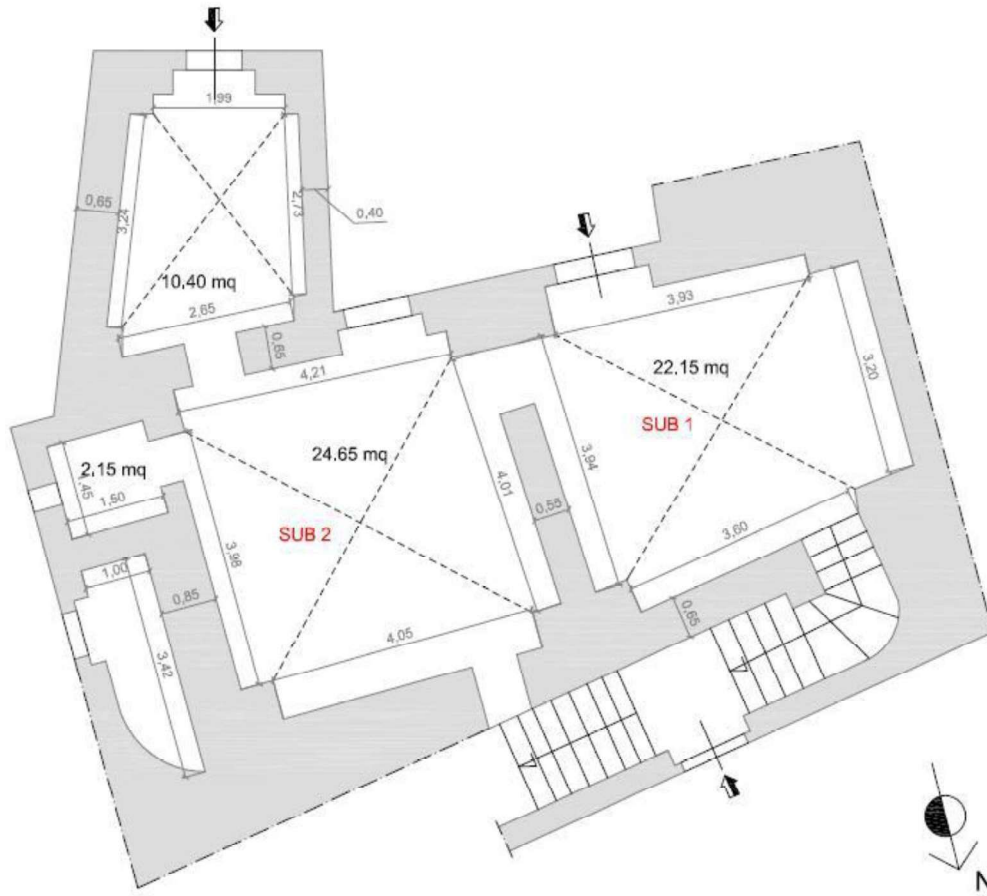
Planimetria Catastale Immobile, Piano T, Foglio 35, p.lla 817, Sub 1-2.
